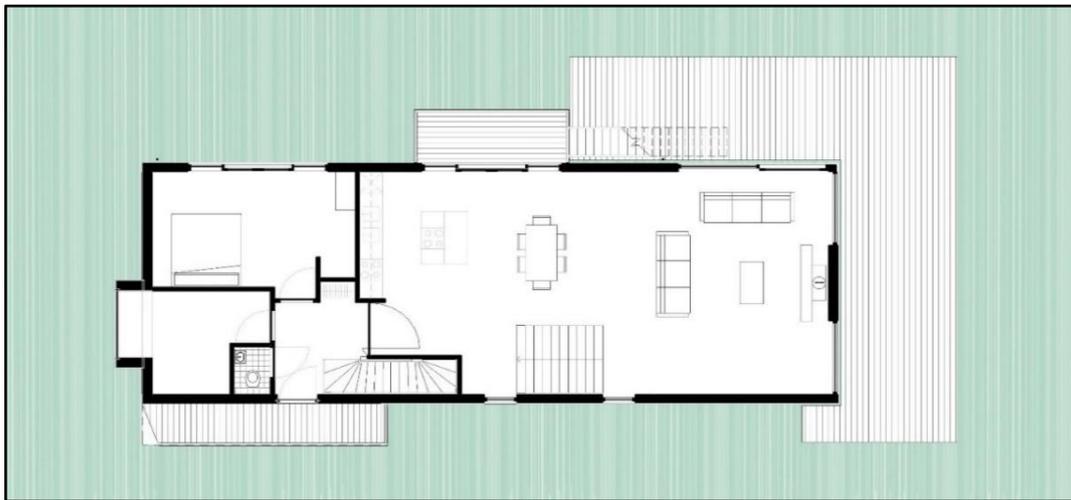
Vista en Planta de Vivienda Tipo 1º piso
